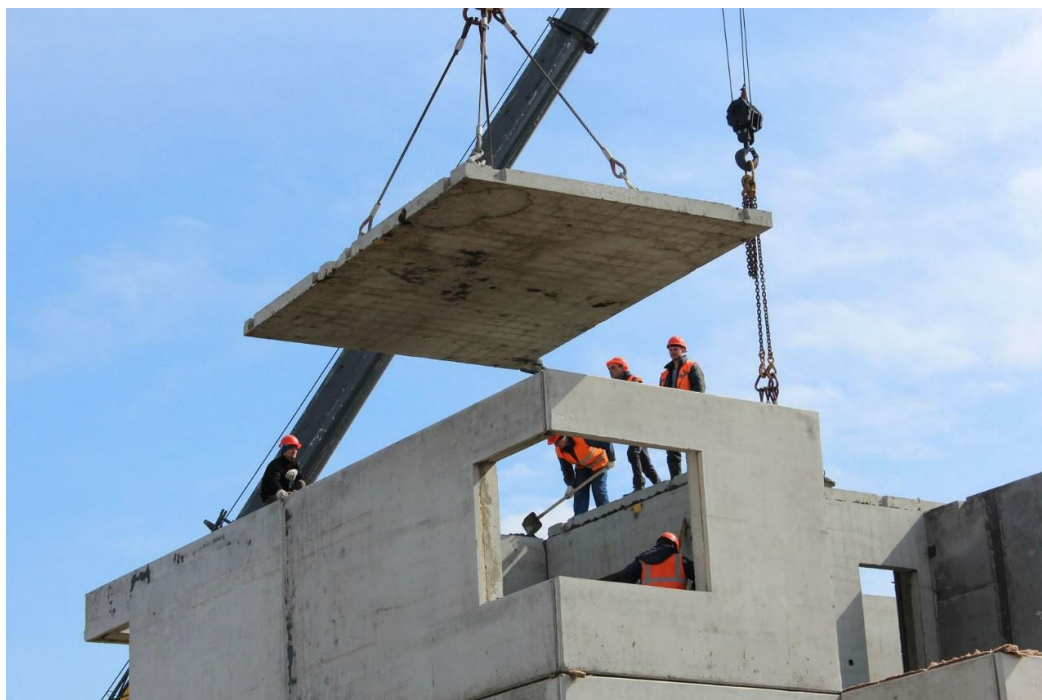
Сплошная железобетонная сборная плита во время монтажа
